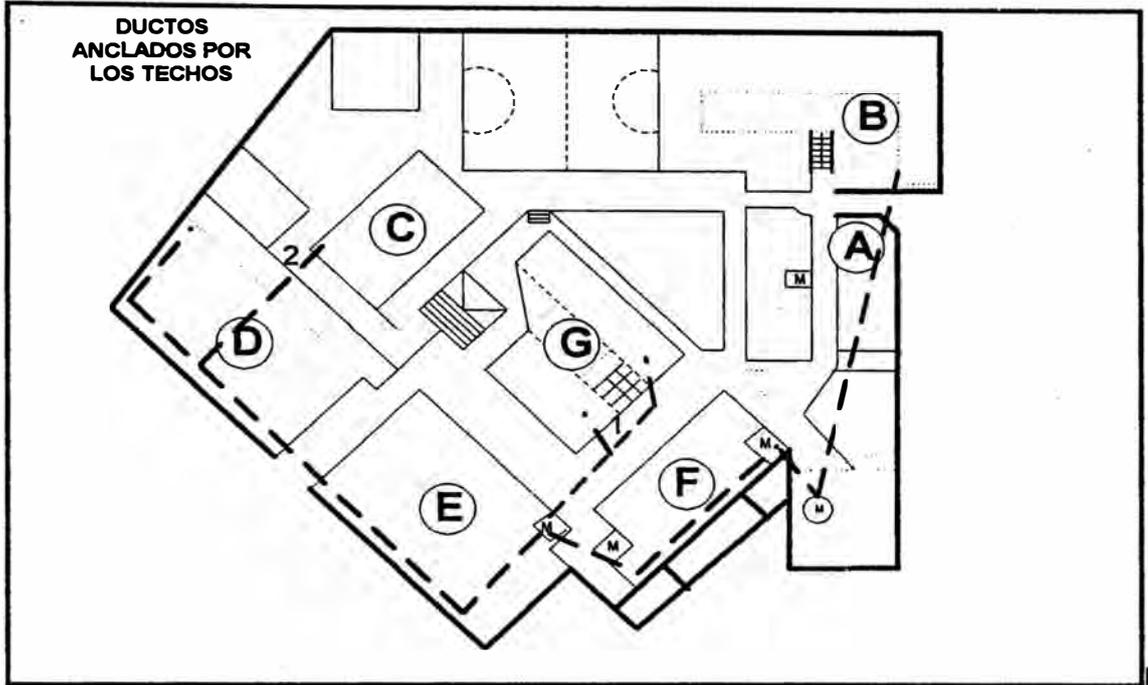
PLANO DE INSTITUCION CON DUCTOS POR LOS TECHOS
